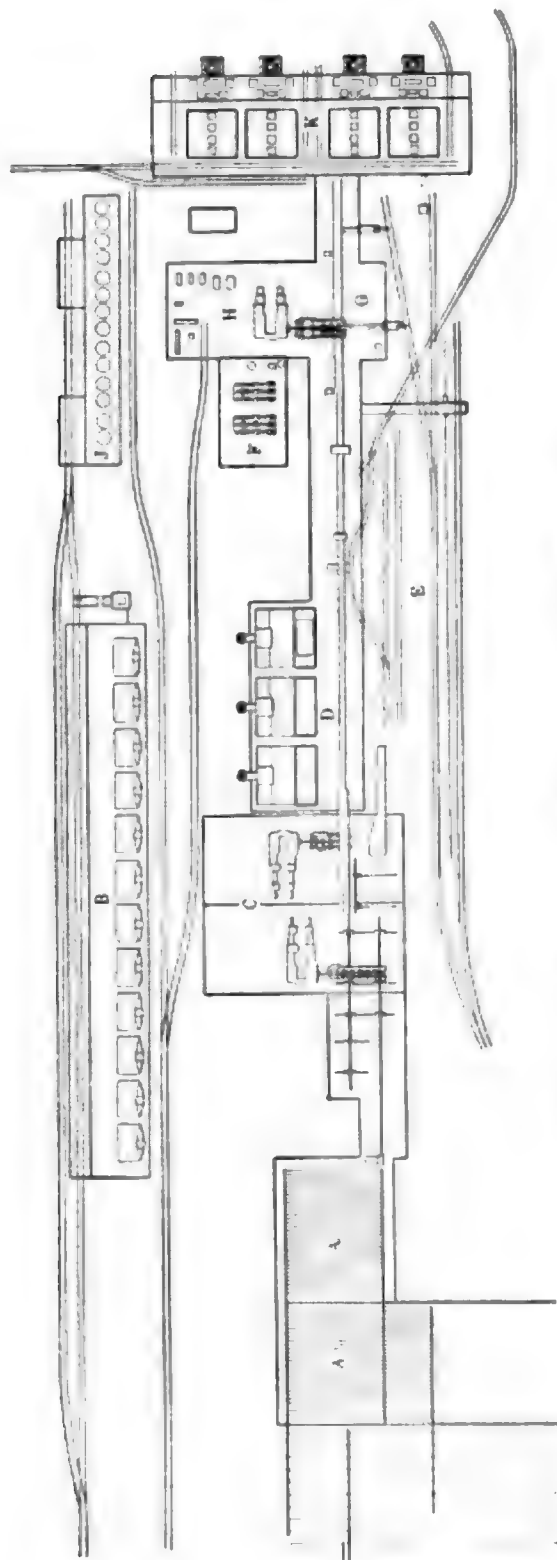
Lageplan des Konstruktionseisen-Walzwerks.
